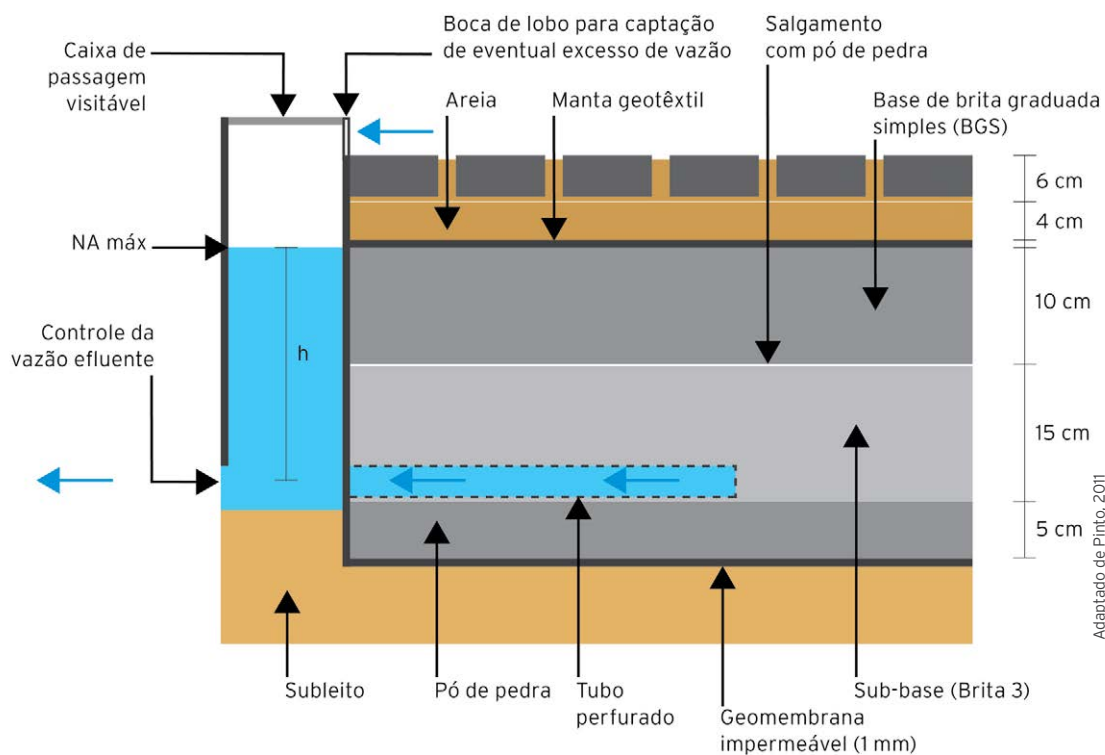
Corte típico de pavimento permeável para tráfego leve revestido de Blocos Intertravados de Concreto, sem infiltração no solo.
